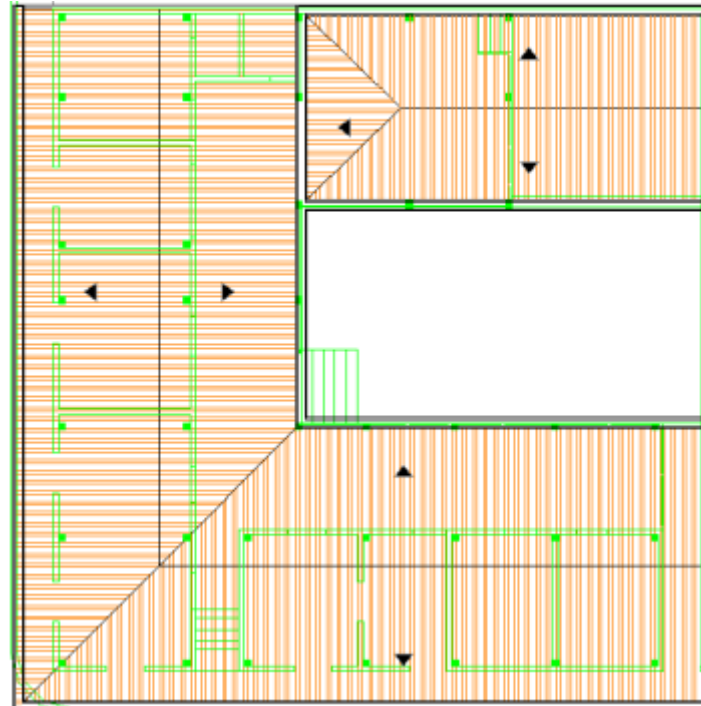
Vista en planta cubierta de la vivienda Eduard Paulus.
